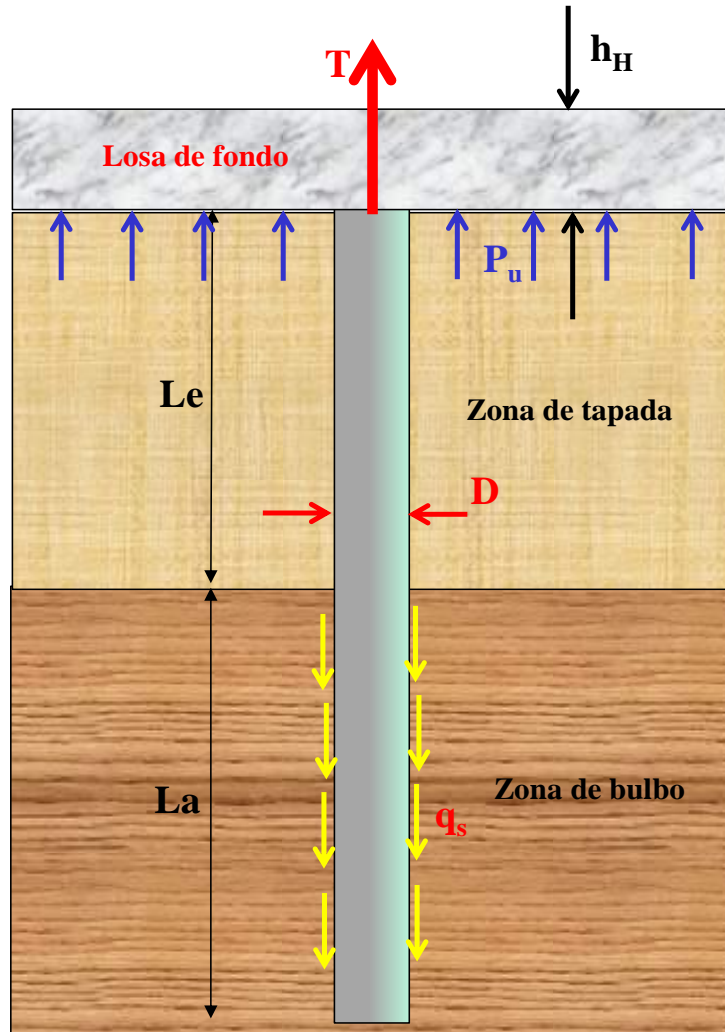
Esquema de cálculo alternativo de anclaje para losa de subpresión
